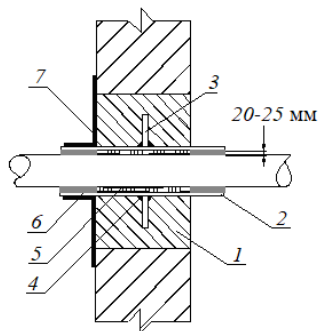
Уплотнение узла прохода труб тепло-водоснабжения в здание: 1 — заполнение проема бетоном; 2 — стальная гильза; 3 — шайба; 4 — сварной шов; 5 — центровка трубы в гильзе с помощью набивки из просмоленной пакли; 6 — заполнение нетвердеющим герметиком на глубину 50 мм; 7 — гидроизоляция
